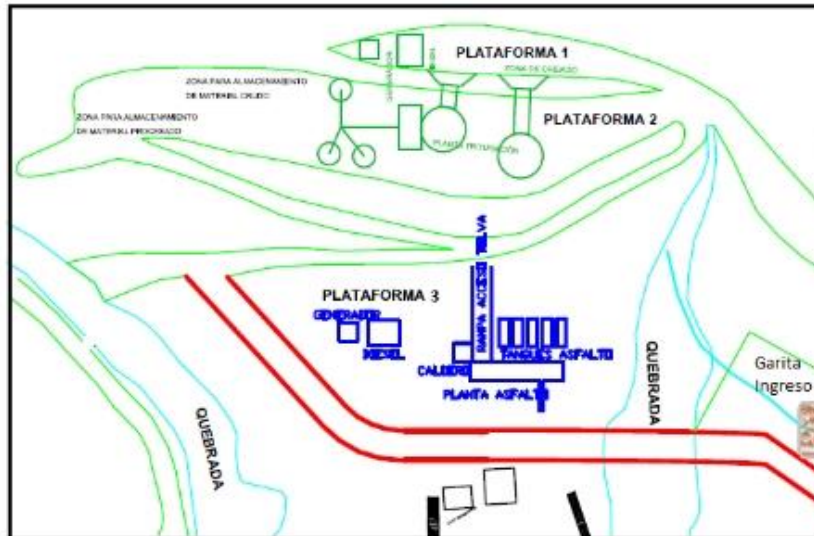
; Lay-out de la Planta; Fuente La Empresa
